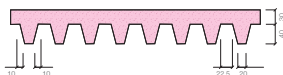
Planta e alçado de um bloco Mursom®, em cm.
